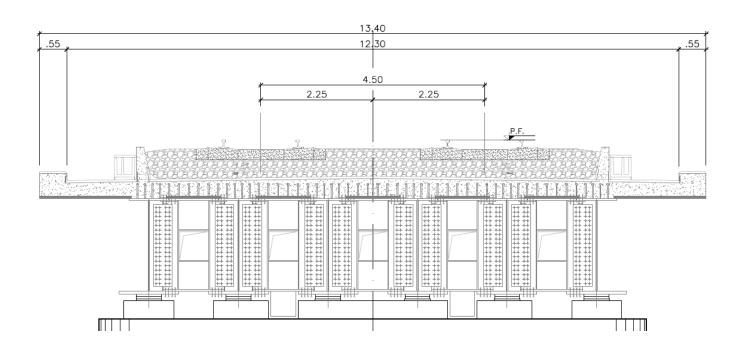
Sezione trasversale tipo dell'impalcato da 40 m (6 travi).
